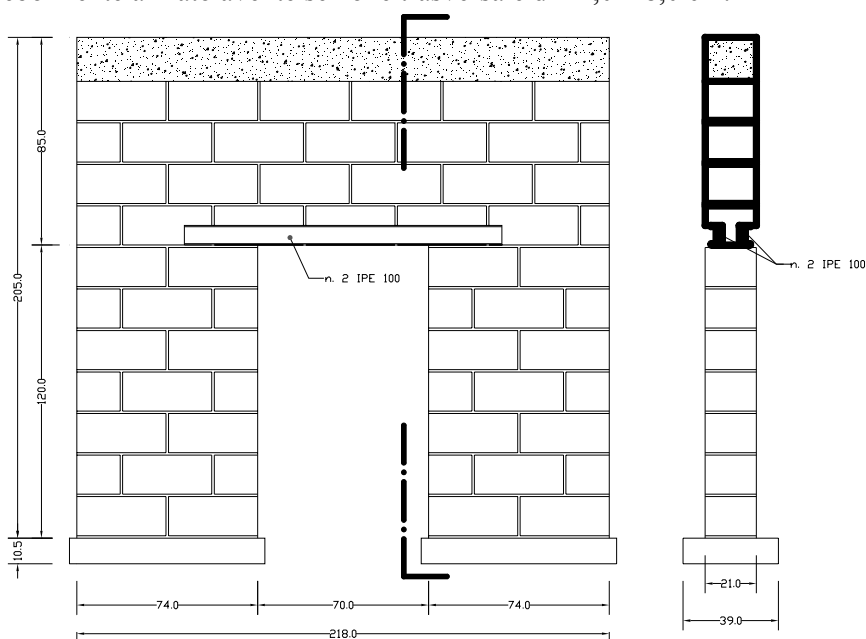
Prospetto e sezione verticale della parete forata oggetto di studio
